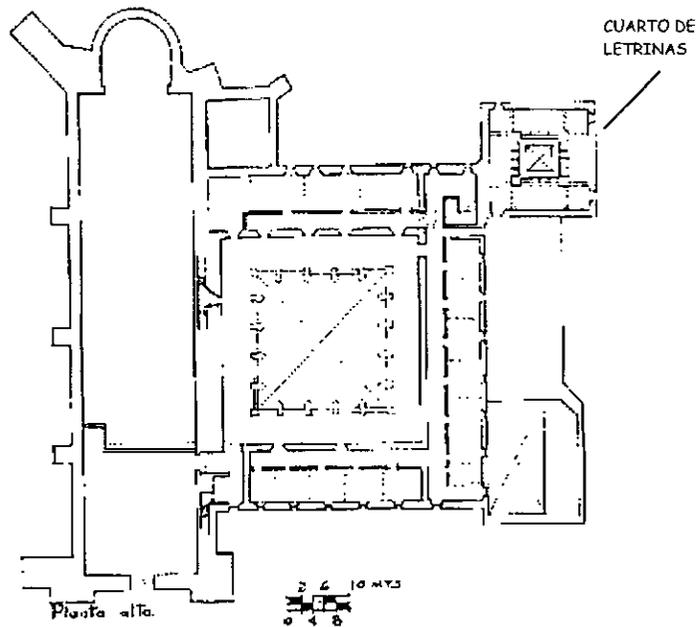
Planta alta del convento de Yanhuatlán, Oaxaca donde se aprecia el cuarto de letrina con una cloaca central que da hasta la planta baja por donde pasa una corriente de agua que sirve como drenaje. (fuente: "Yanhuatlán...")
